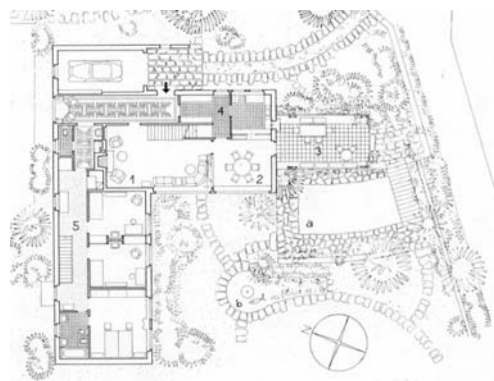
Hans Hofmann, Eigenheim, 1940/1941, Grundriss Erdgeschoss
